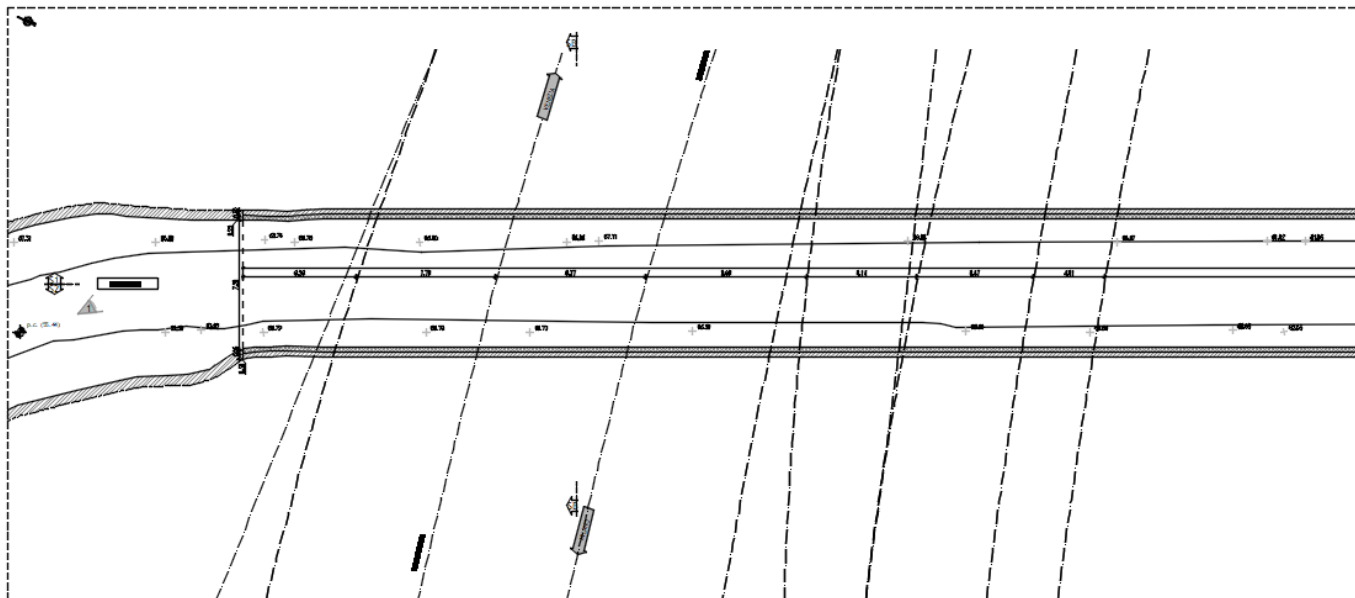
Planimetria Ponte Camuzzoni a livello della struttura
